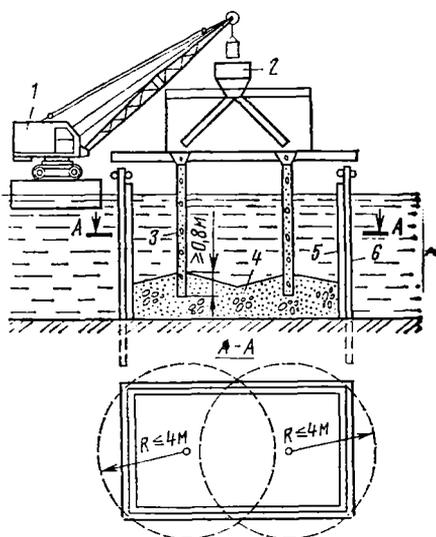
Схема подводного бетонирования способом ВПТ:
